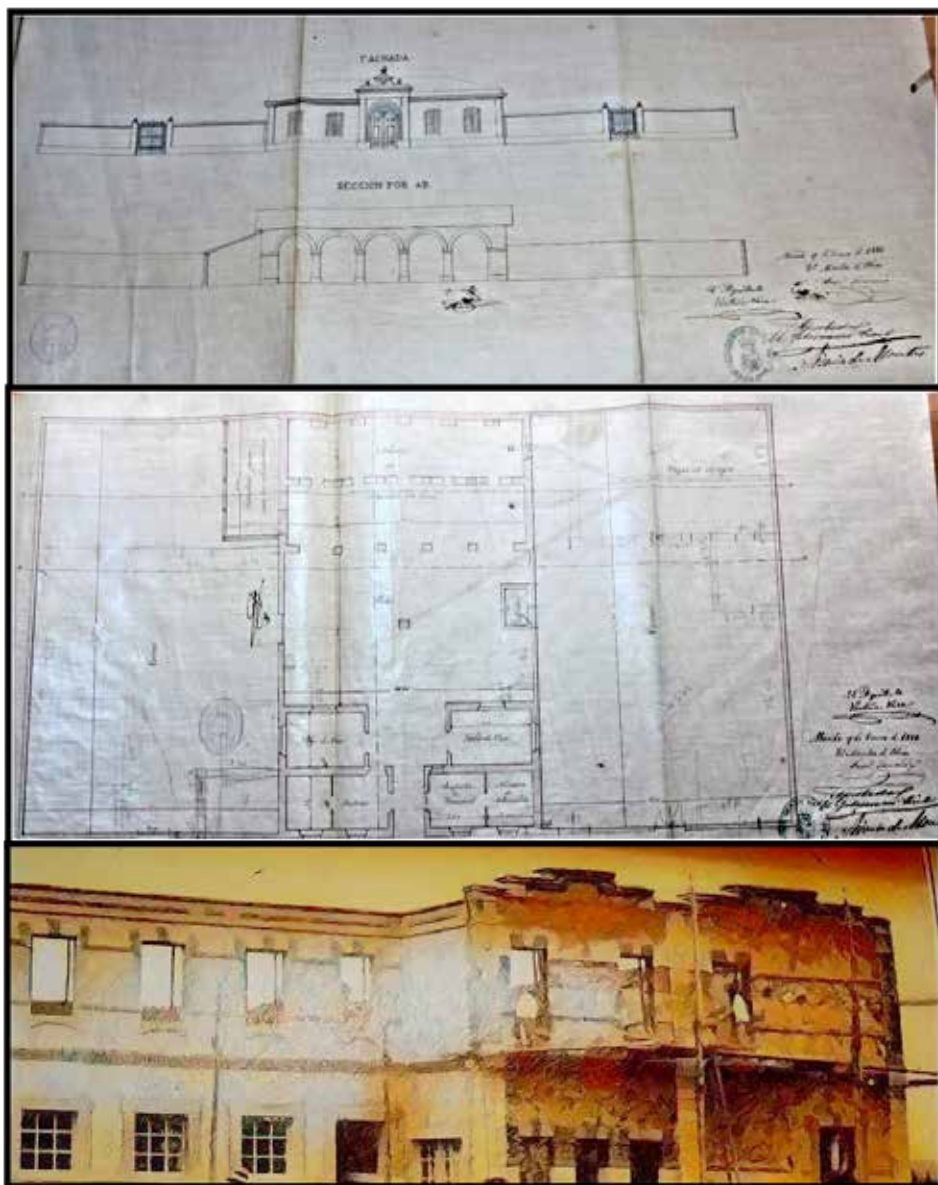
Plano del primer matadero levantado en Mérida²¹⁶. Es posible que el segundo matadero, ya destruido también, fuera levantado siguiendo los planos del arquitecto ya que se observan las mismas líneas que las trazadas por él para los mataderos de Alburquerque o Montijo. Fuente: Legajo 558. AHMM y AFFVM.
